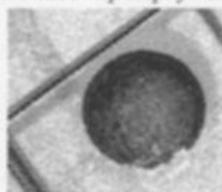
Контроль заполнения бетонной смесью нижней зоны плиты перекрытия с пустотами в виде призм пенополистирола
